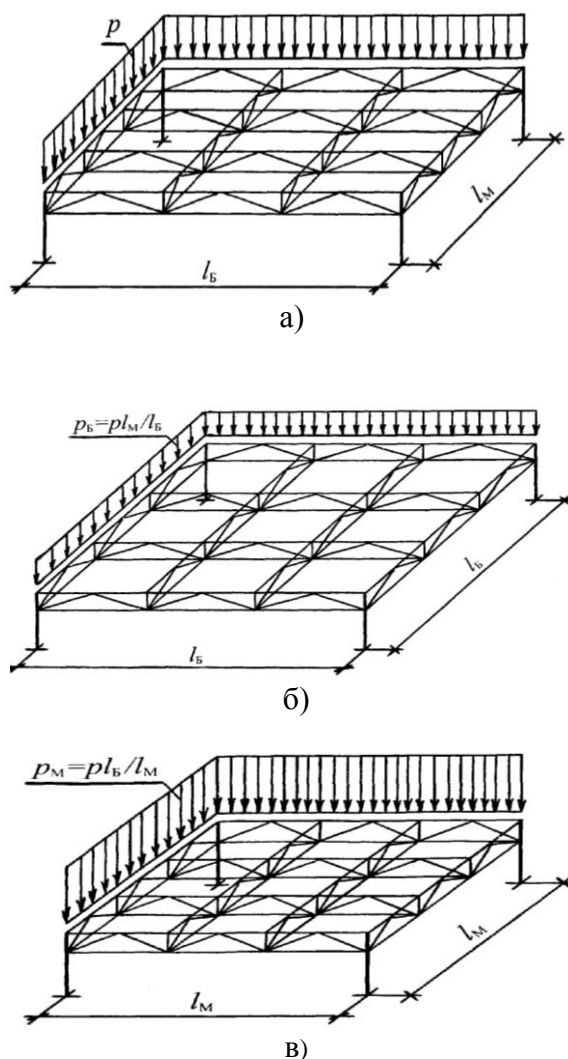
Схемы расчетной модели прямоугольной сетке колонн
